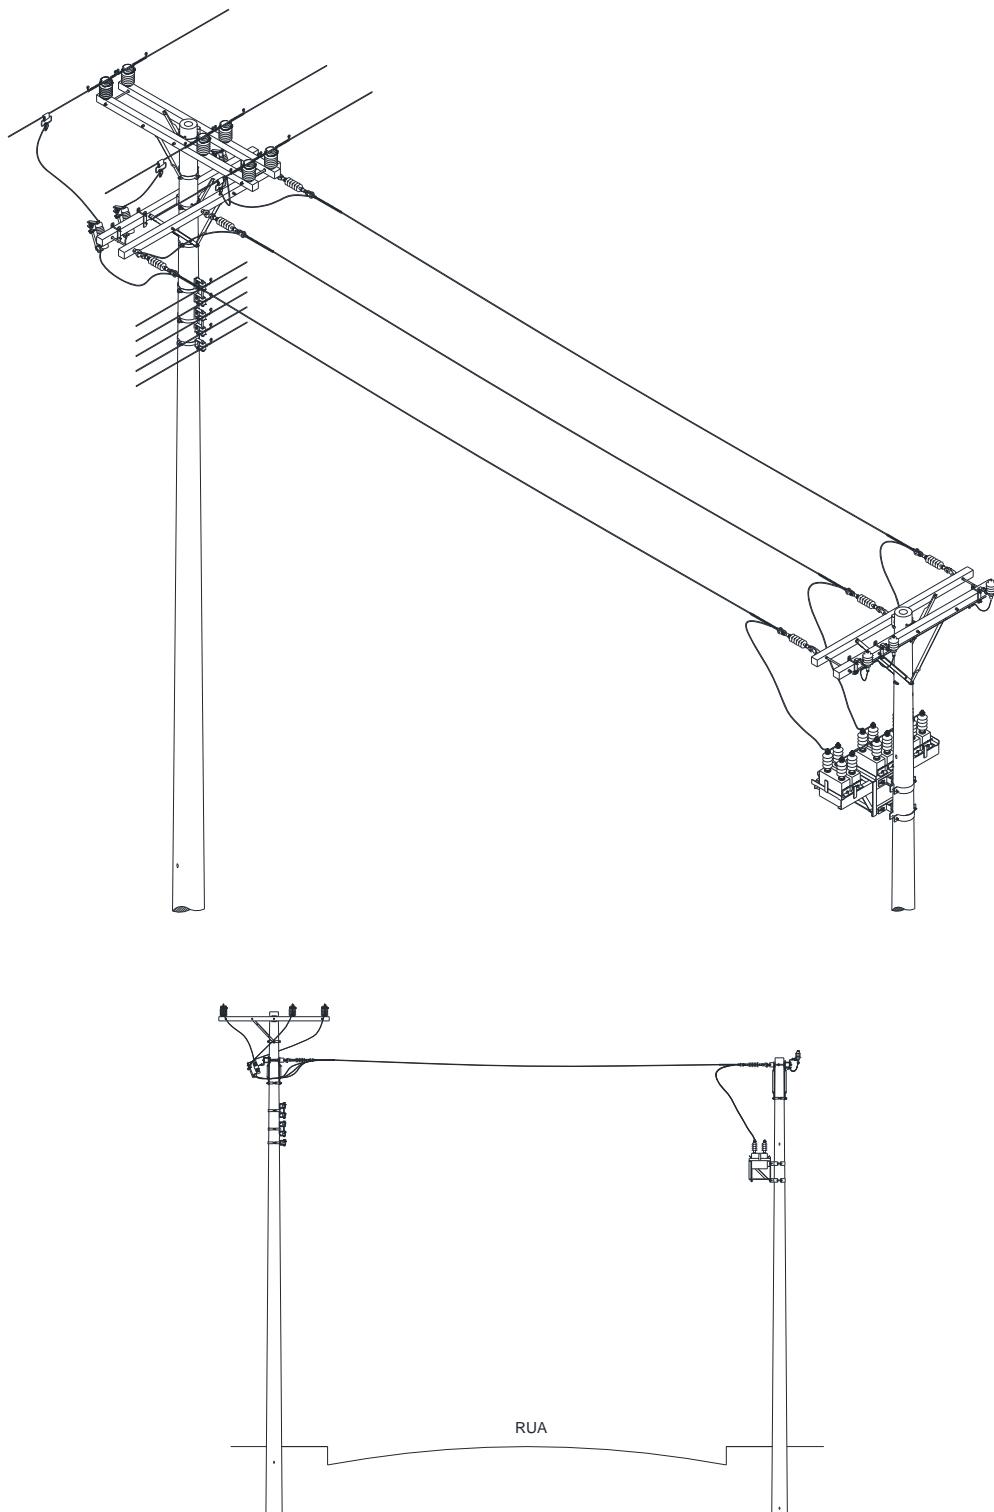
Instalação de equipamento – Banco de capacitor em rede existente – Alternativa
